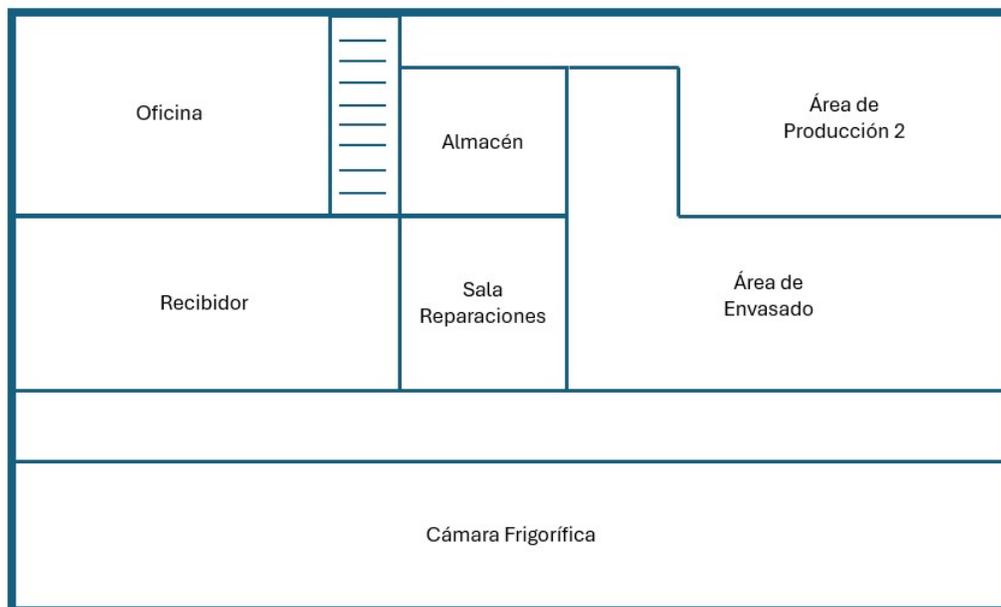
Esquema de la Fábrica: Planta Baja.
